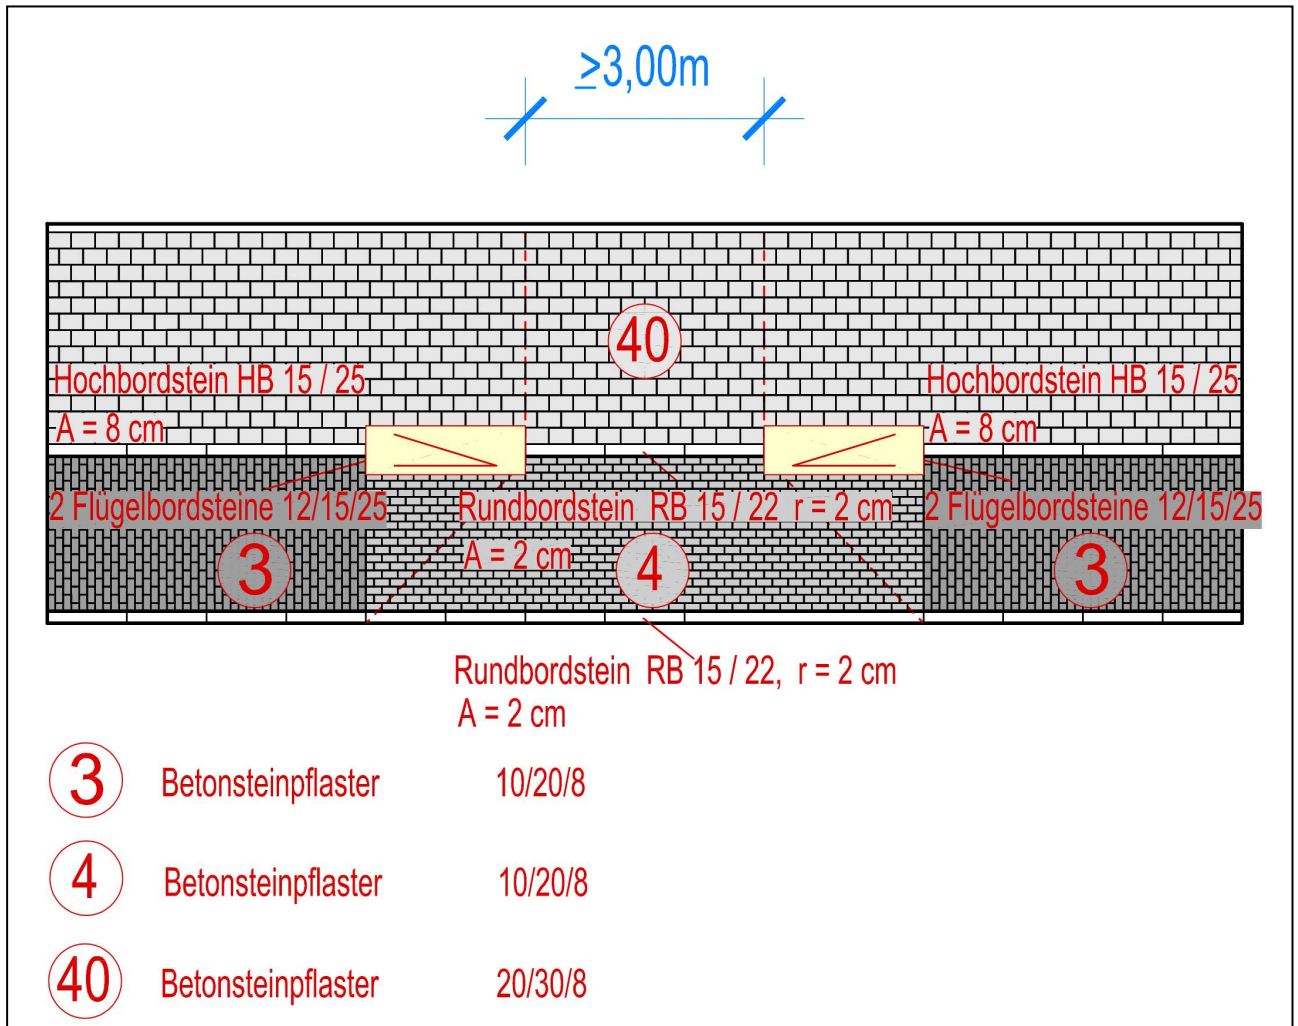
Grundstückszufahrt mit Parkstreifen (Alternativlösung)
